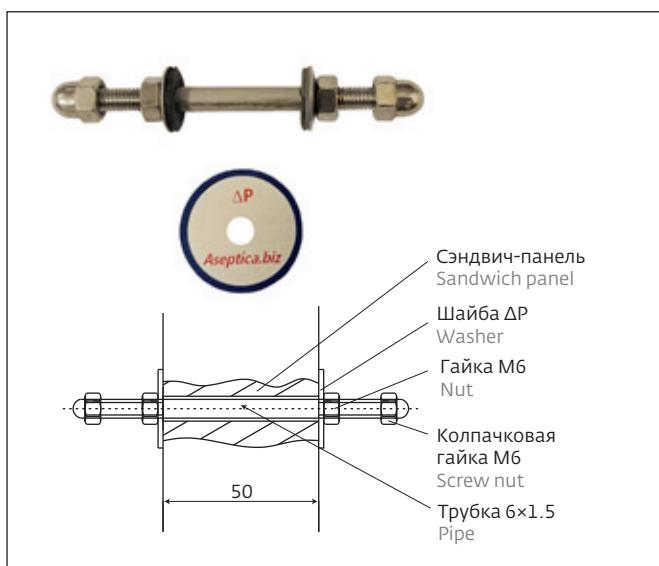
Порт ΔP : вверху: внешний вид устройства, внизу: чертеж
